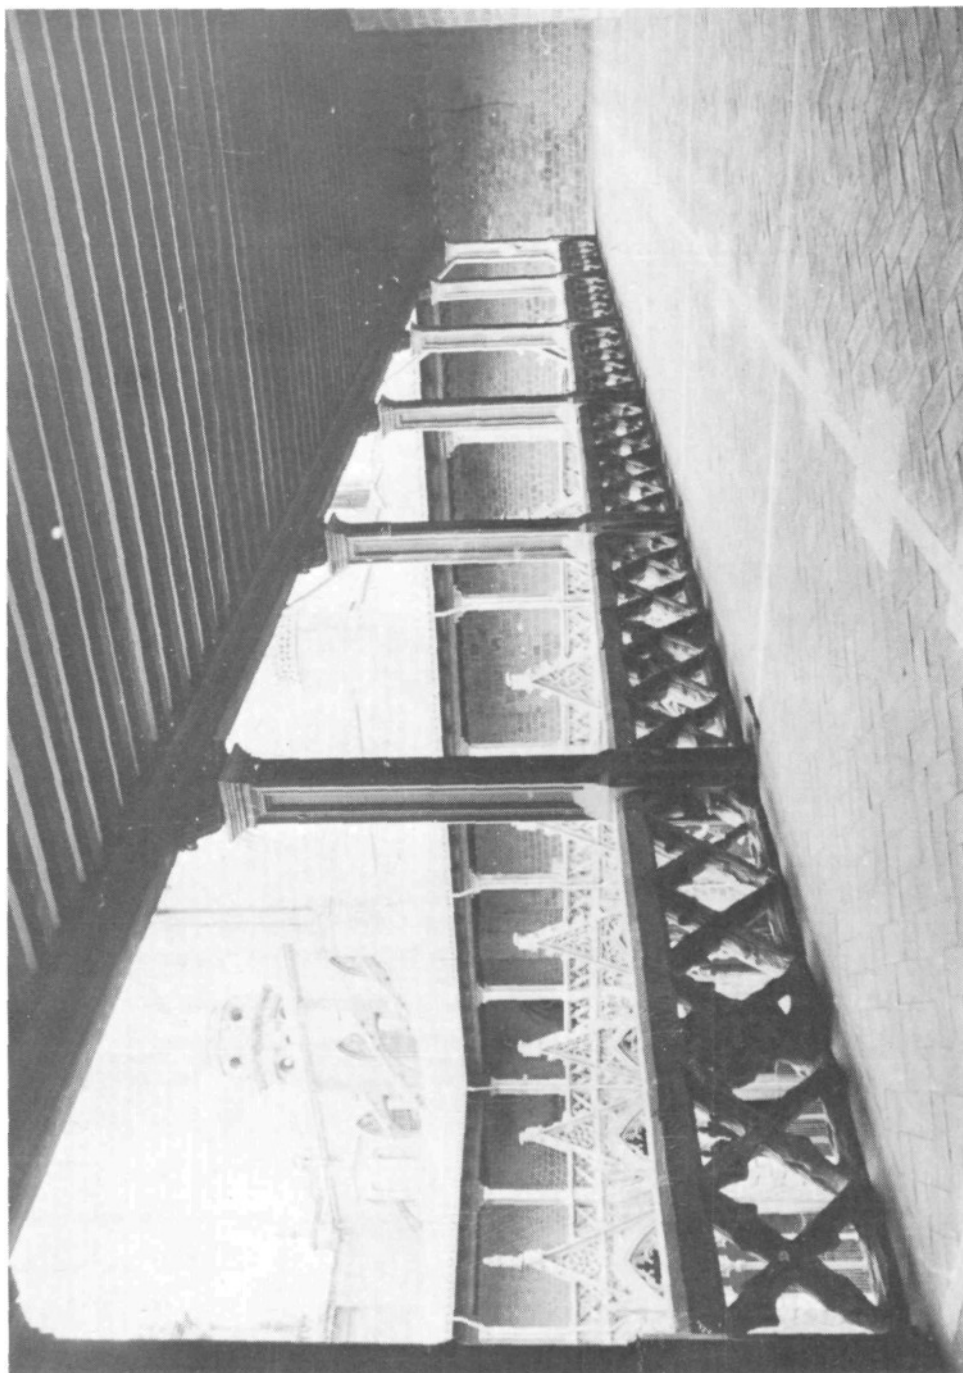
Vista de las galerías del sobre-claustro terminadas.
